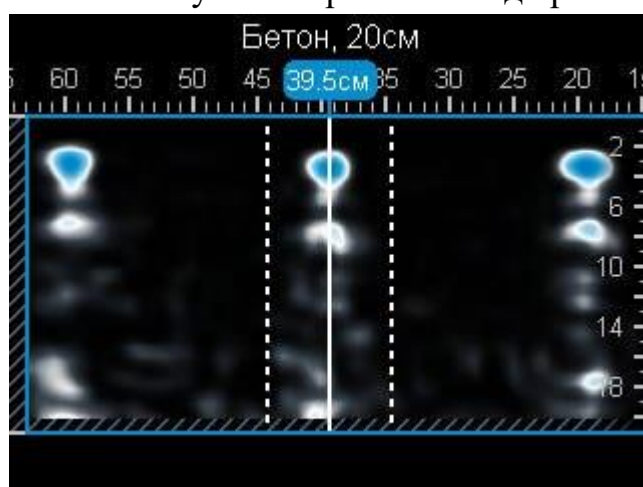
Расположение армирования по наружной стороне кольцевой железобетонной стены опоры. Защитный слой 20мм. Шаг 200мм
